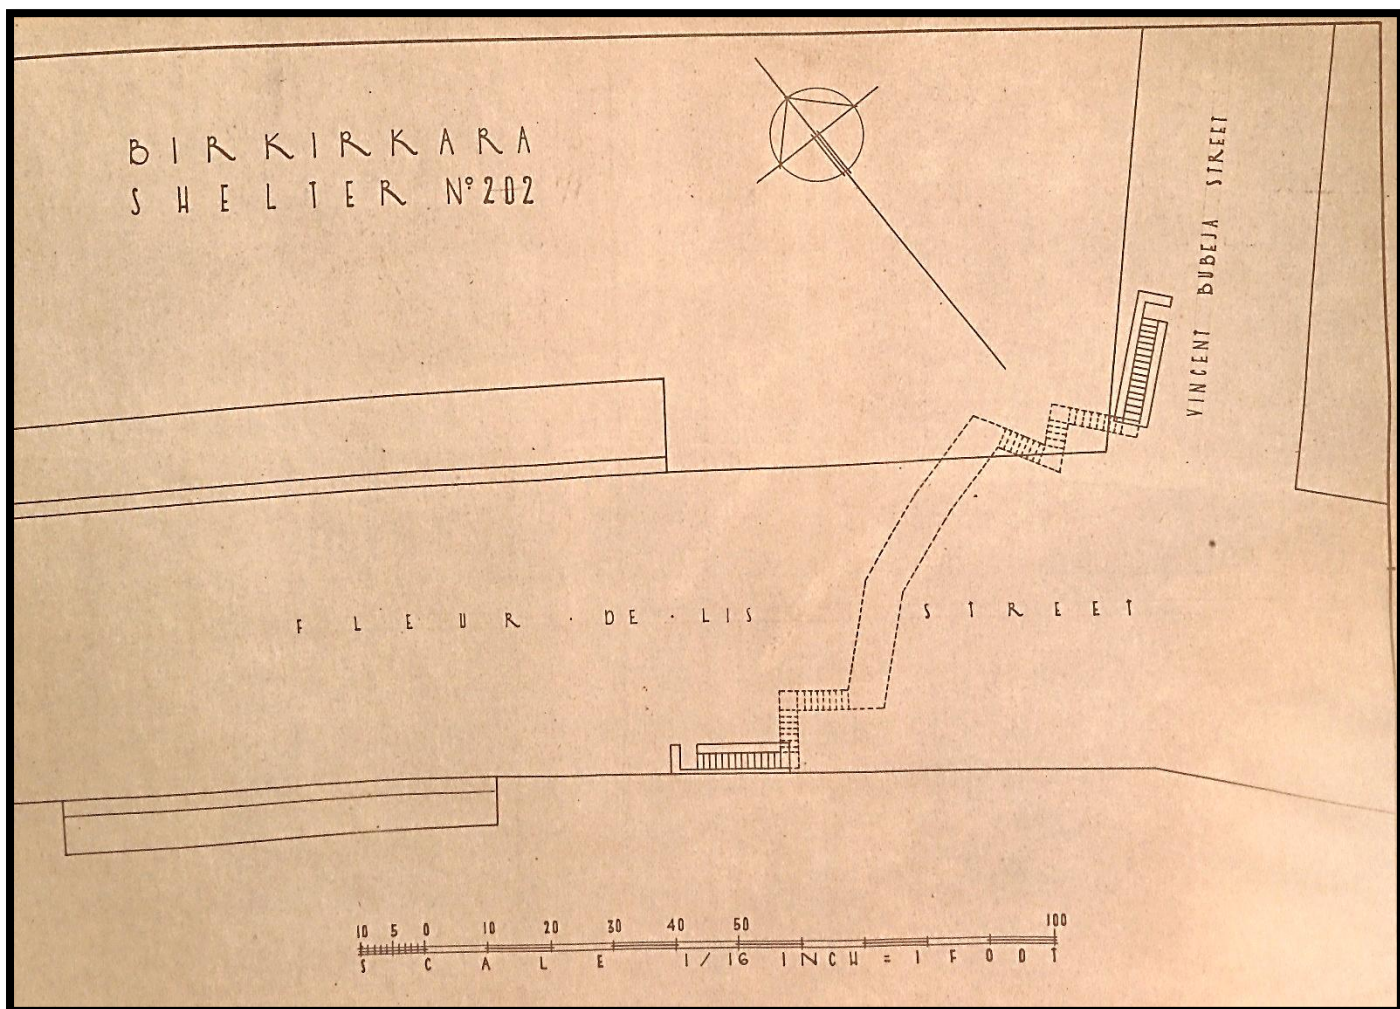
Planta do Abrigo nº 202 (71) "Fleur-de-Lis Street – Vicent Bubeja Street"
